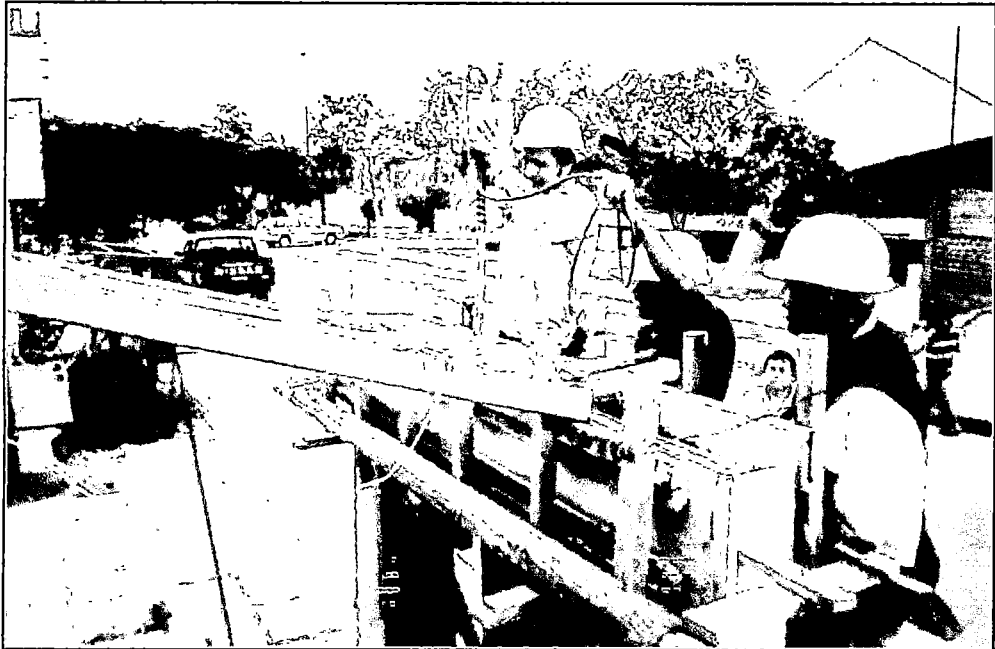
Vaciado de concreto de viga. (Variante VI)
